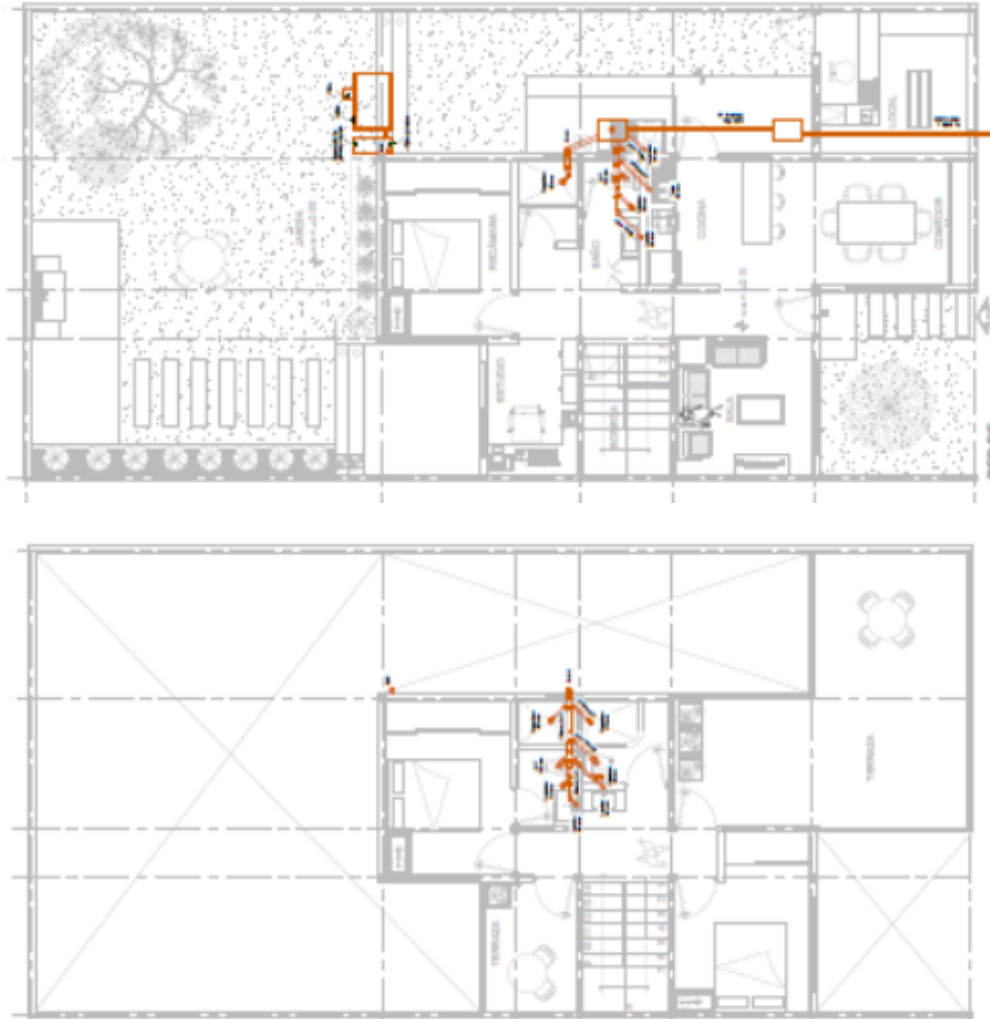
Plano Sanitario de prototipo de vivienda B. Plano de elaboración propia, 2017. Plano INS-SA, véase pág. 180.
